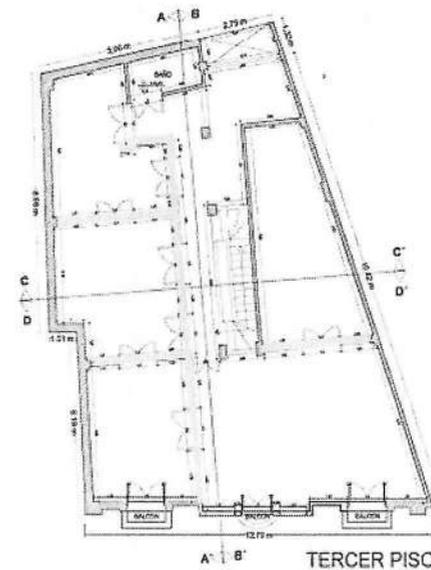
Plano de levantamiento (muros propuestos a demoler)
